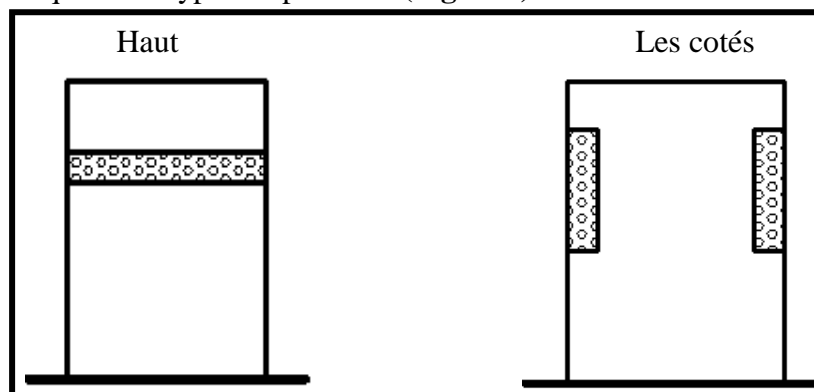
Position des ornements sur la façade du palais consulaire
